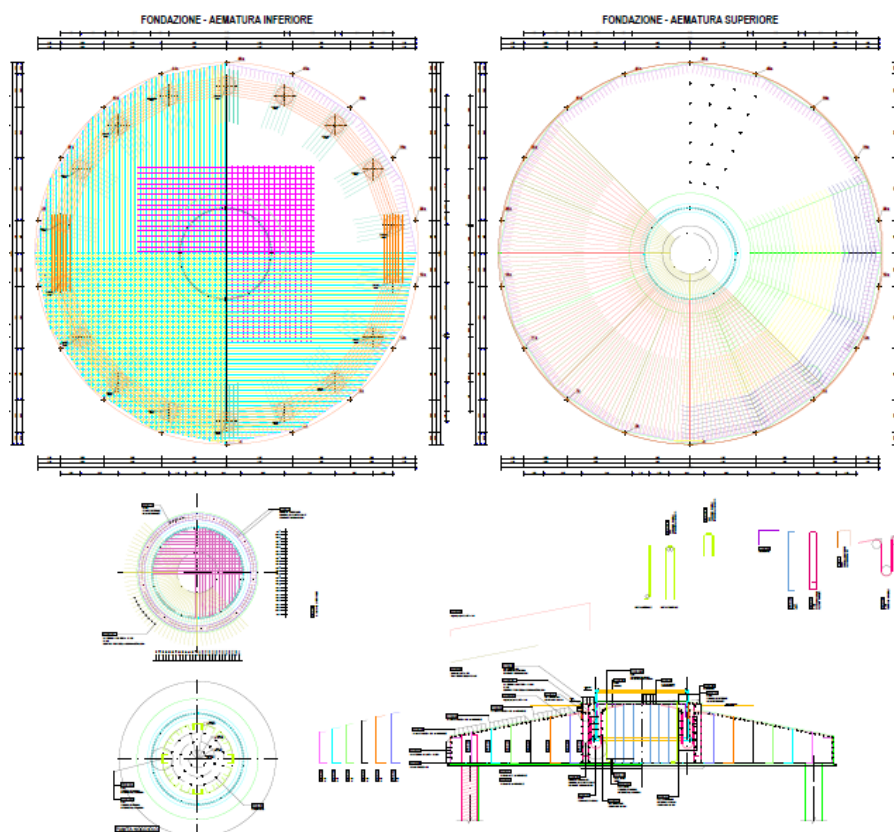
Pianta-sezioni e armature del plinto di fondazione
